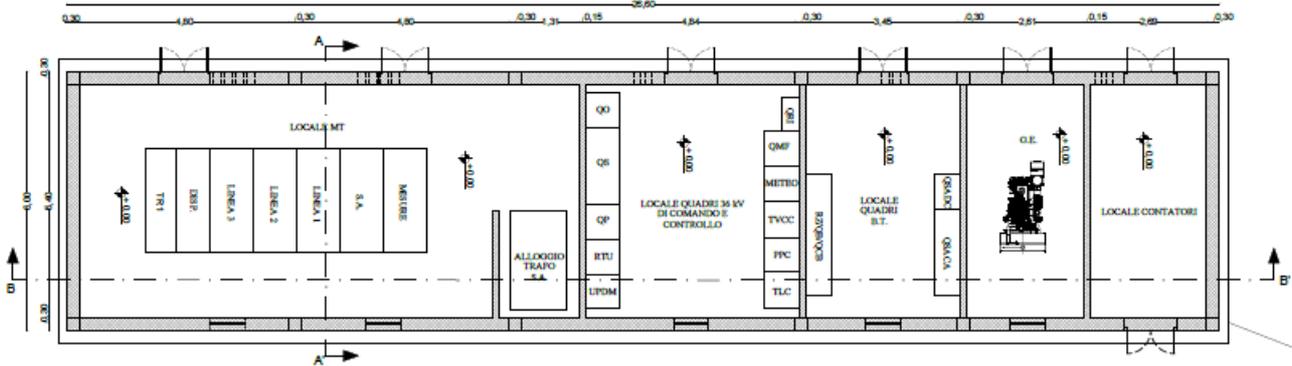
Schema costruttivo in pianta dell'area/Cabina a 36kV in progetto
